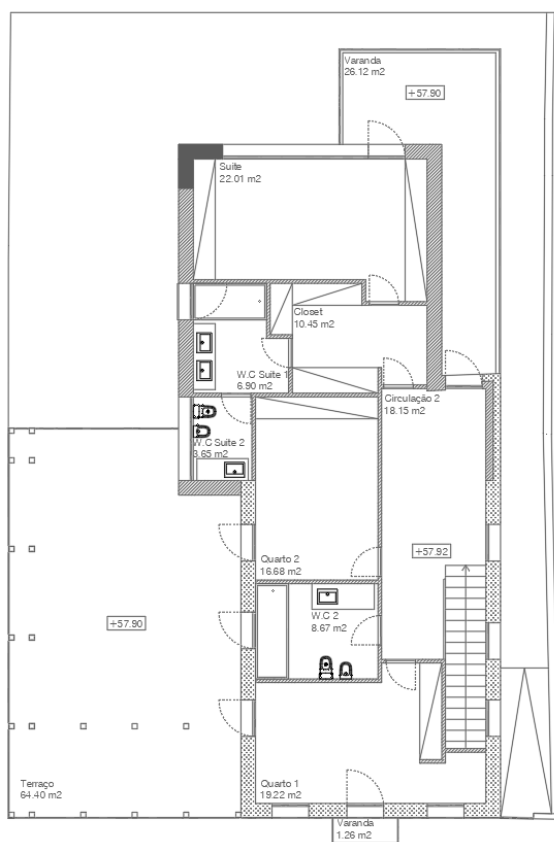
Piso elevado planta nova (Projeto de arquitetura).
